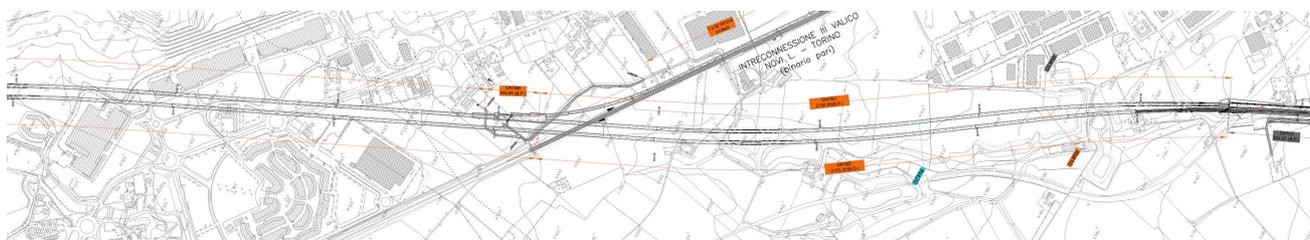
Planimetria generale della Galleria Serravalle –settore di pianura – imbocco nord (pk 32+850 – 36+350.88)
